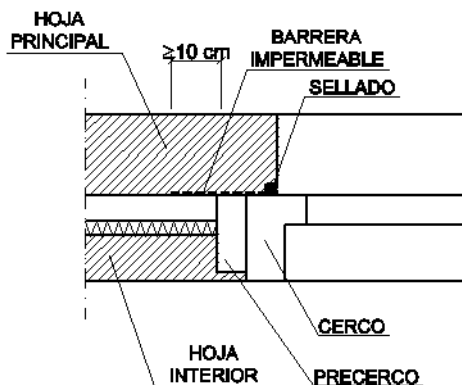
Ejemplo de encuentro de la fachada con la carpintería
